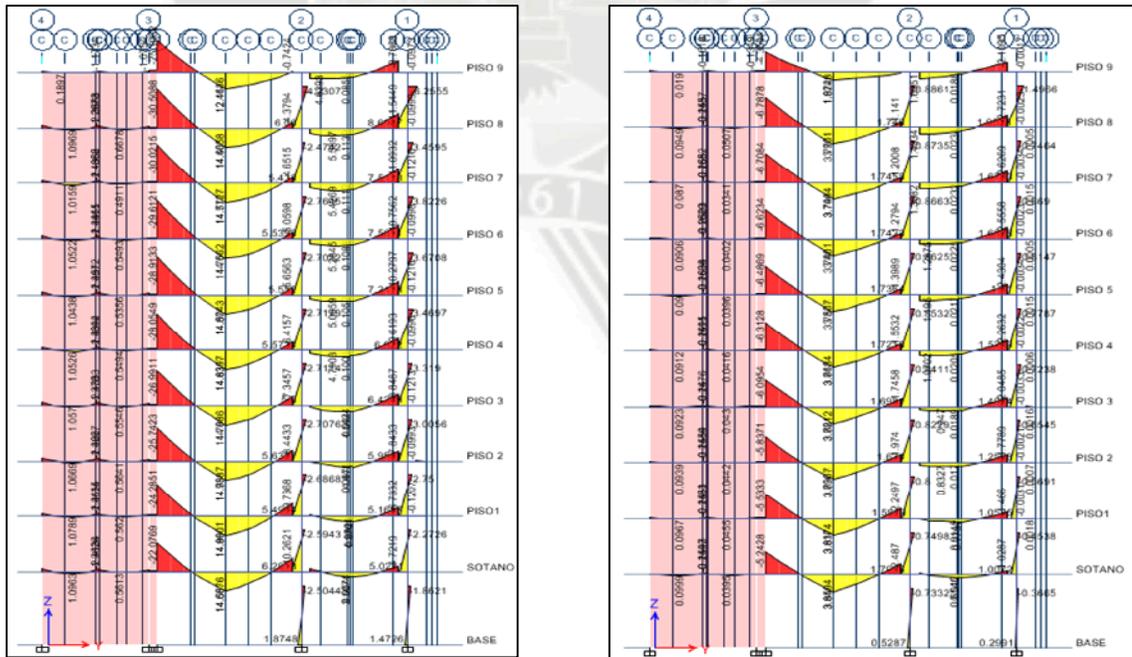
Fuerzas Internas Actuales sobre el Pórtico "A" debido a las Cargas Muertas y Cargas Vivas.
